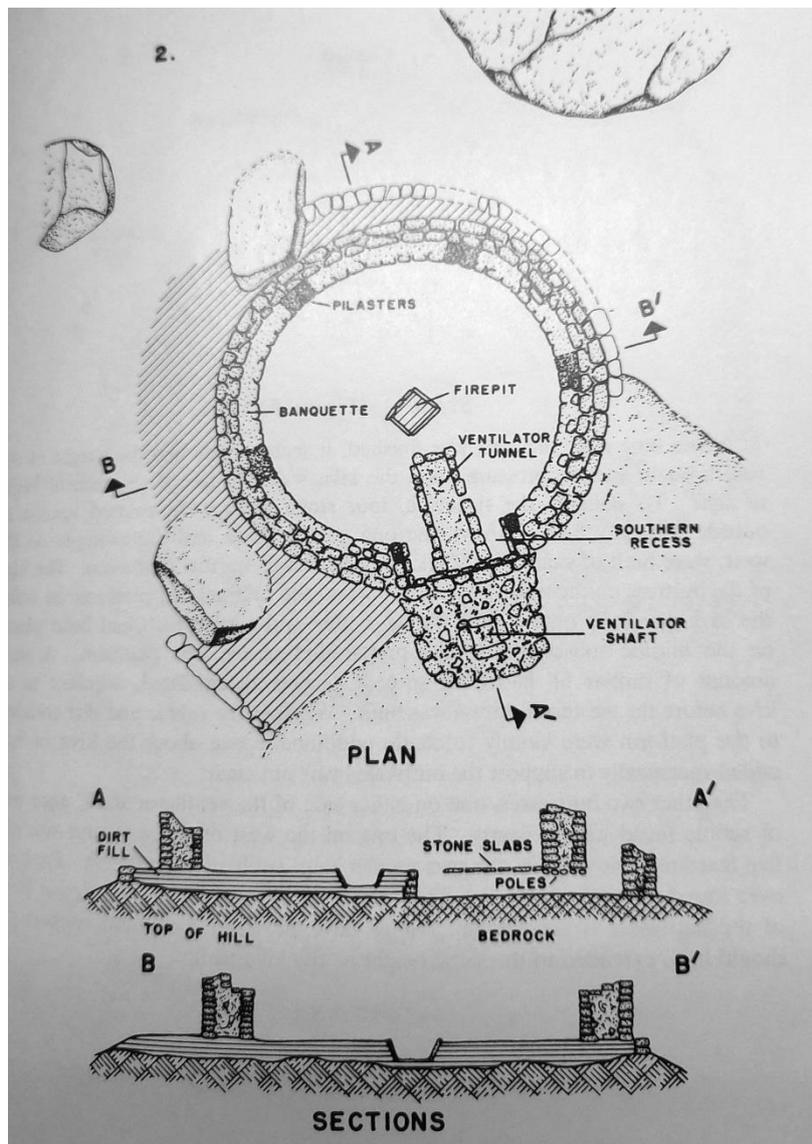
Plan zénithal et en section d'une kiva à Mesa Verde (dans LISTER, 1967, p. 15)
